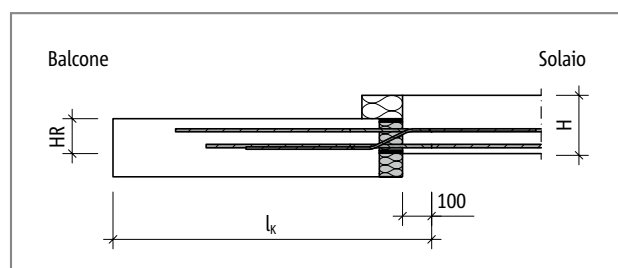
Schöck Isokorb® T tipo KL-UD: schema statico
